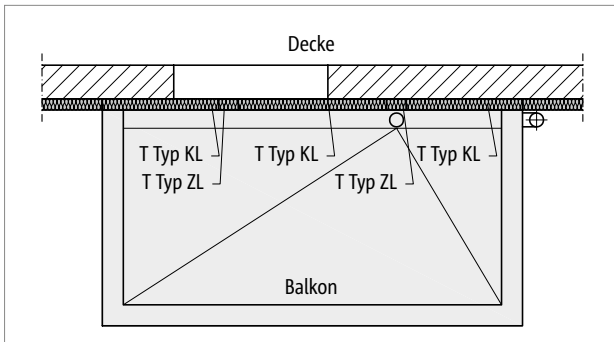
Schöck Isokorb® T Typ ZL, KL: Aussparung für Entwässerung mit Schöck Isokorb® T Typ ZL
